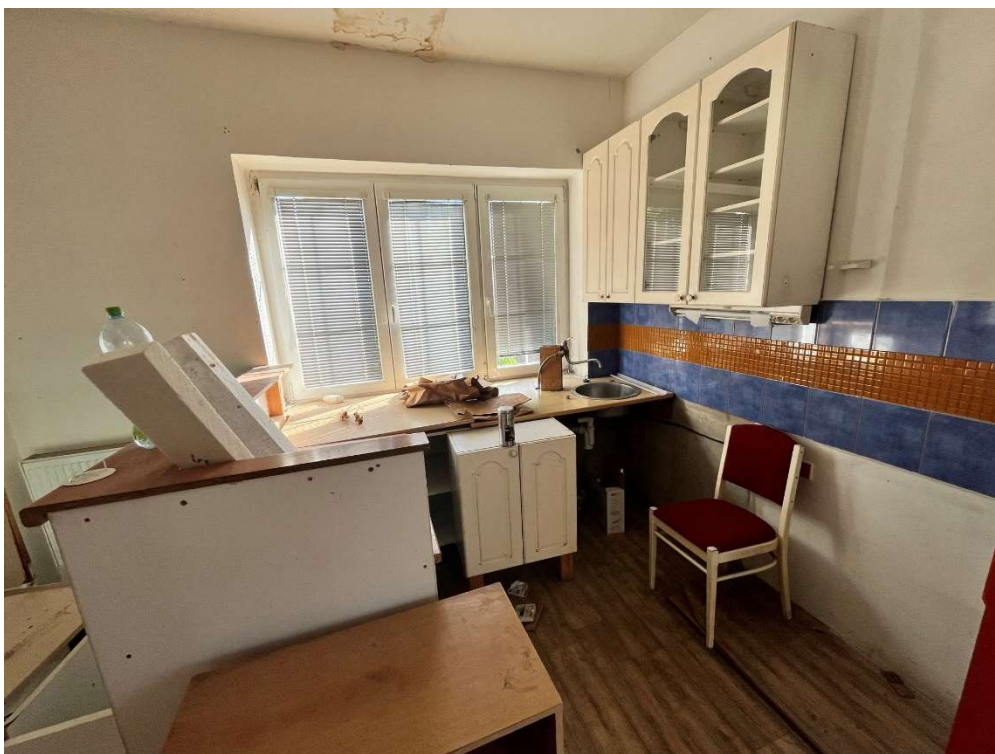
Fotografie stávajícího stavu – pokoj INP
